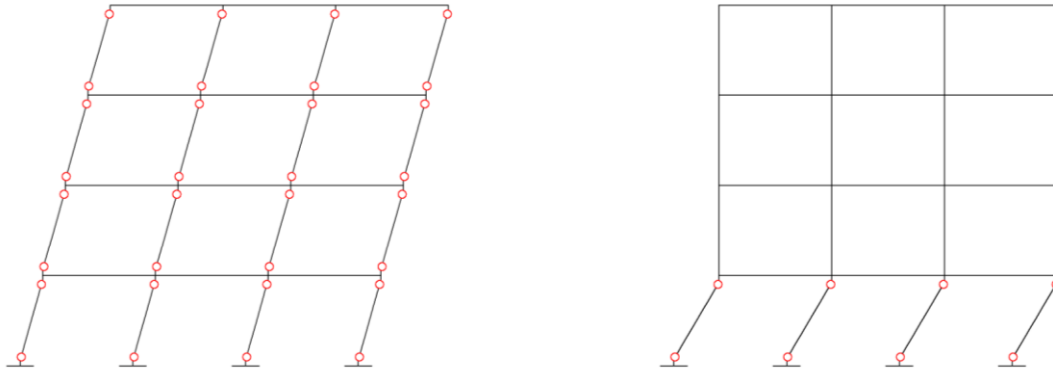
Patrón de colapso lateral viga fuerte – columna débil
